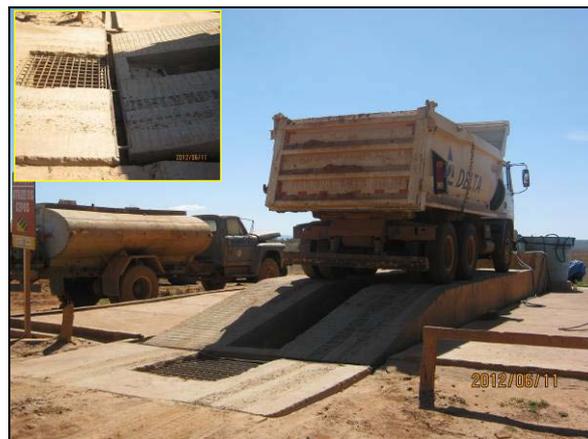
Lava jato com piso impermeabilizado e canaletas de drenagem ligadas ao SAO (jun/2012).
